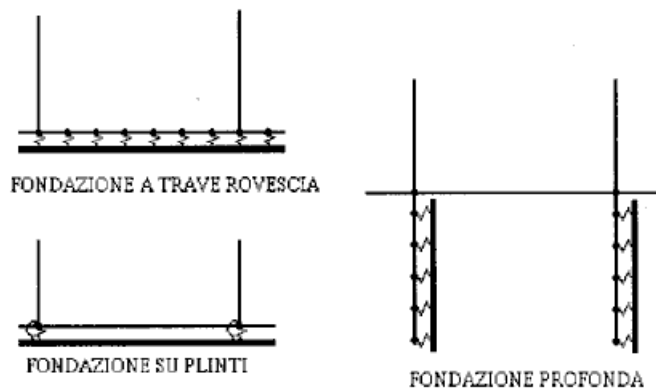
Modellazione delle fondazioni con elementi trave ed elementi molla
